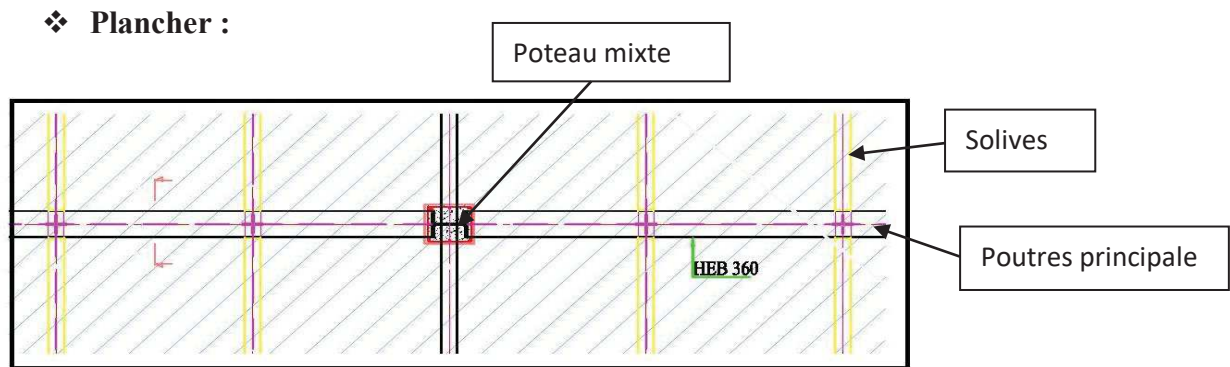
l'effort sollicité sur poteau par les solives et poutres
